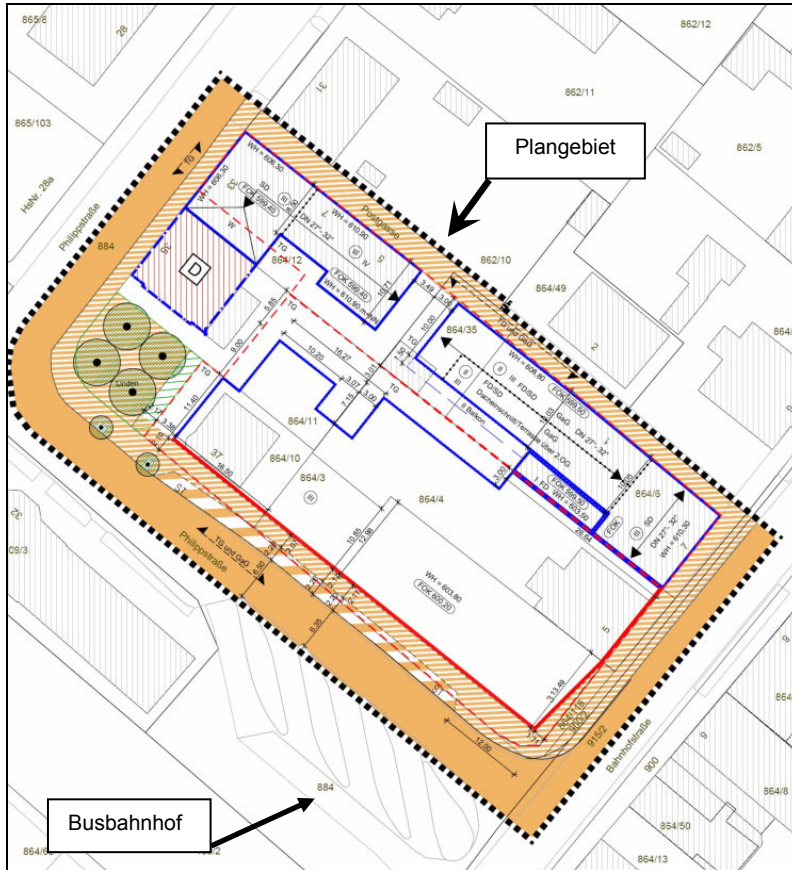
Bebauungsplan "Innenstadt VI", Erdgeschosslage
